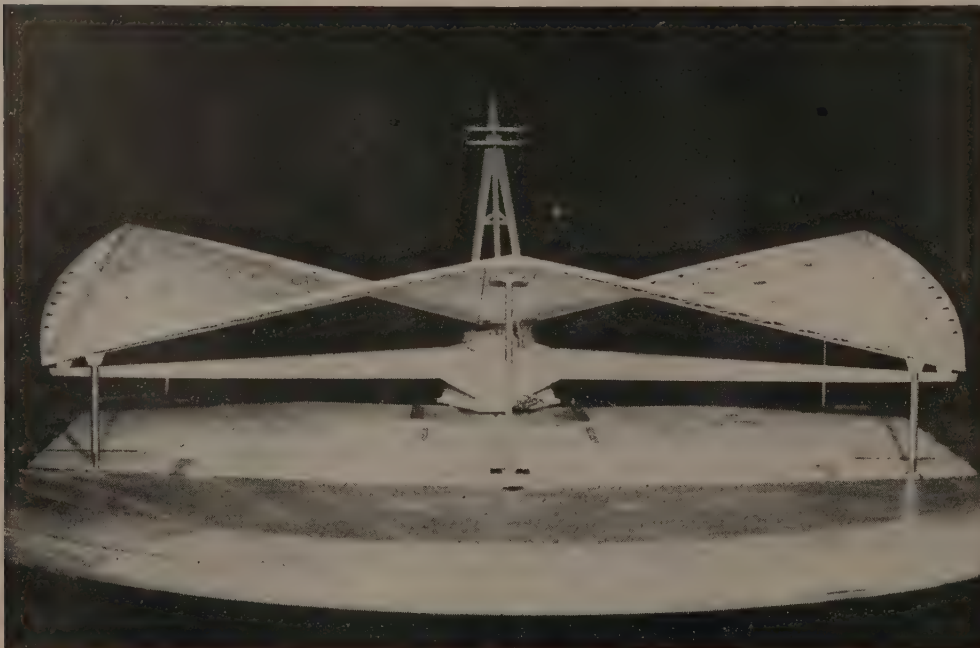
Toiture. Signal. Poutres diagonales. Vue côté face sud.
